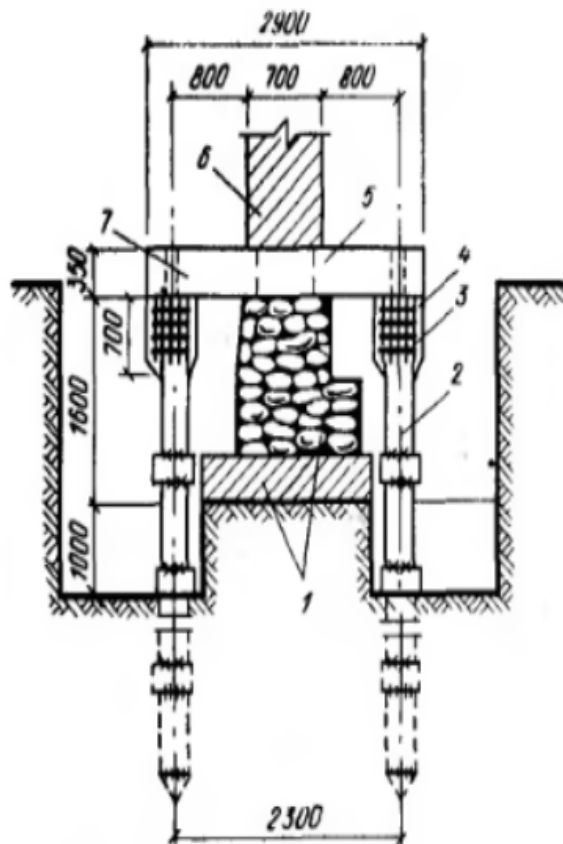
Схема підсилення фундаменту за допомогою вдавлених металічних палей: 1 – існуючий фундамент, 2 – металічні трубчаті палі, 3 – арматурний каркас оголовку палі, 4 – оголовок палі, 5 – монолітні залізобетонні балки, 6 – стіни будівлі
